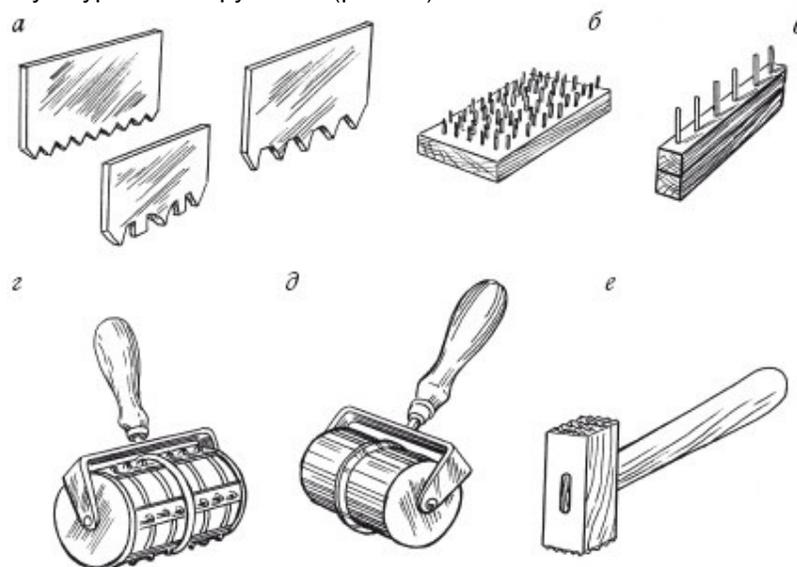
Инструменты для обработки декоративной штукатурки: а – цикли; б – звездчатая щетка; в – гребенка; г – валик; д – валик-шовник; е – бучарда
